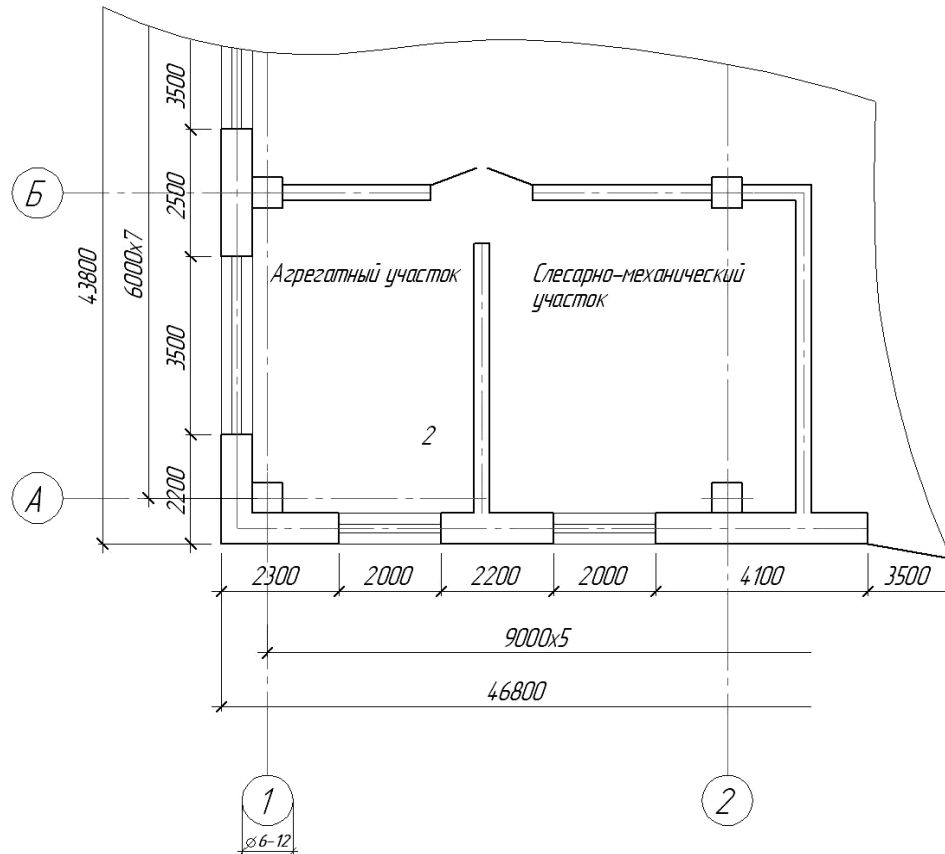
Приклад виконання елементів креслень плану будівлі
